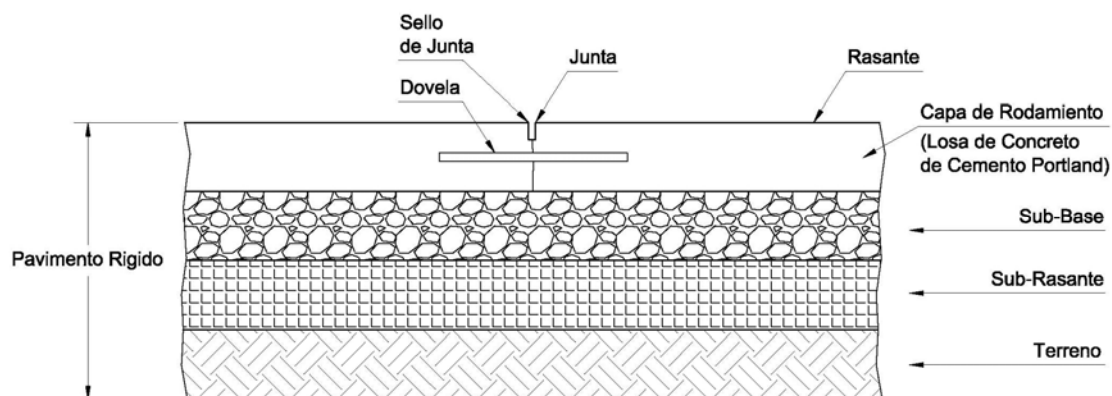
Esquema básico de la estructura de un Pavimento Rígido.
